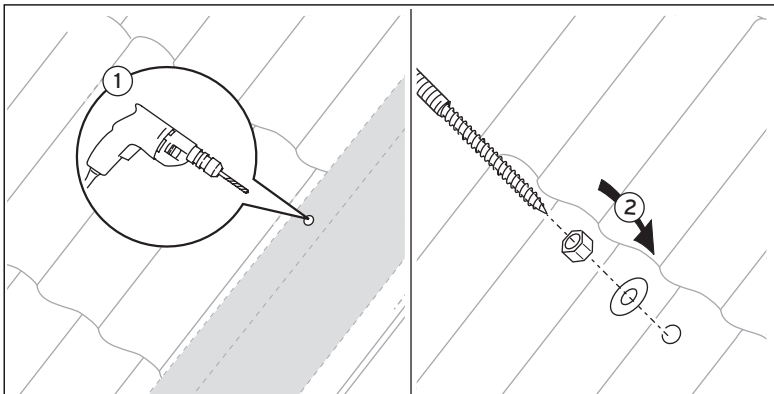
Position des Dachankers auf dem Dachsparren festlegen
